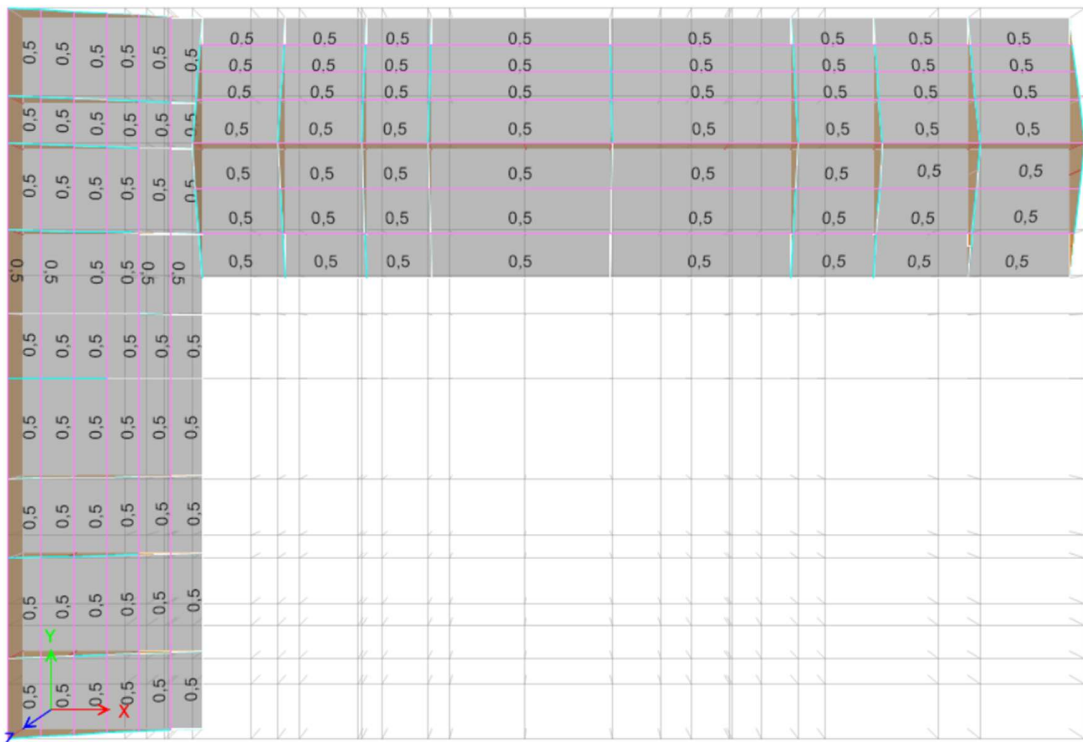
Aplicación de Carga muerta para las losas 2,5
